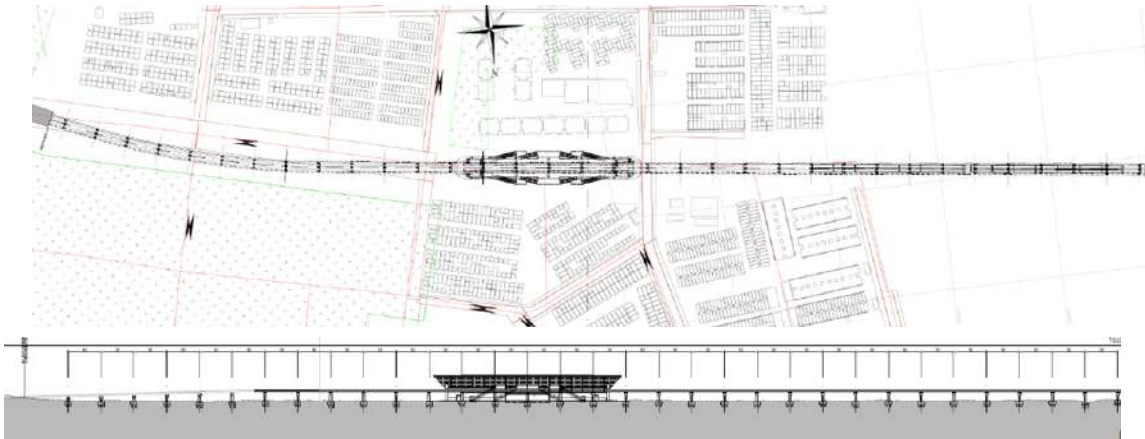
Planta y perfil longitudinal del viaducto elevado y planteamiento de pilas
